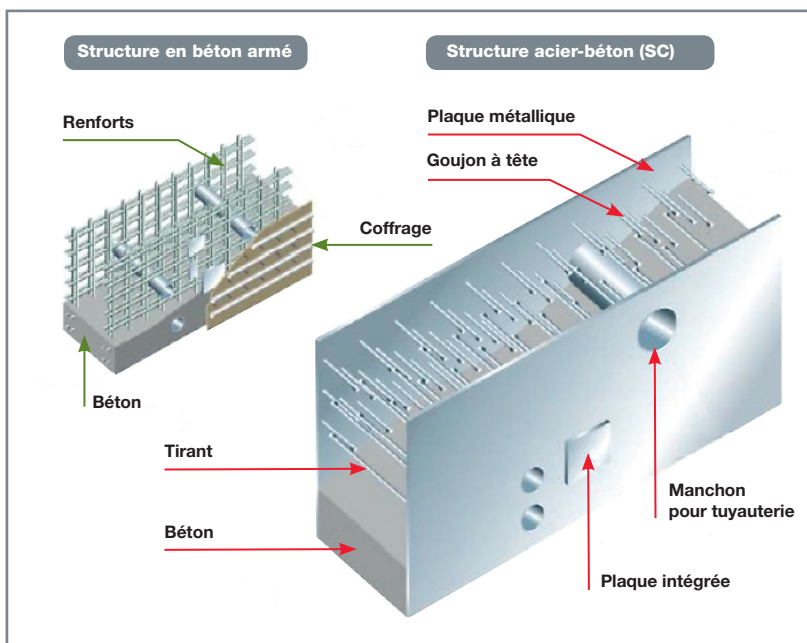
Comparaison entre béton armé et steel concrete (SC).
